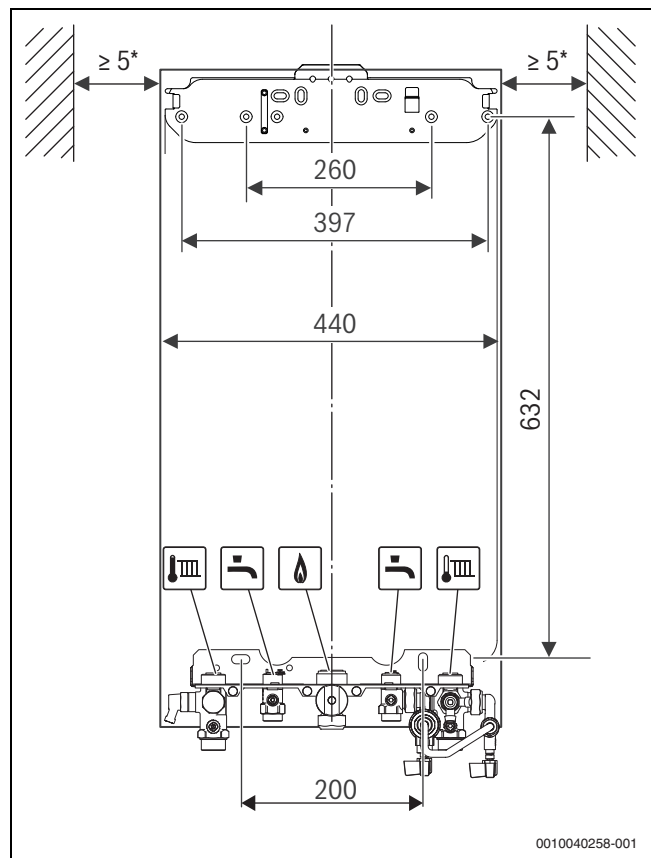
Frontansicht (mm) mit Montageanschlussplatte (Zubehör)
